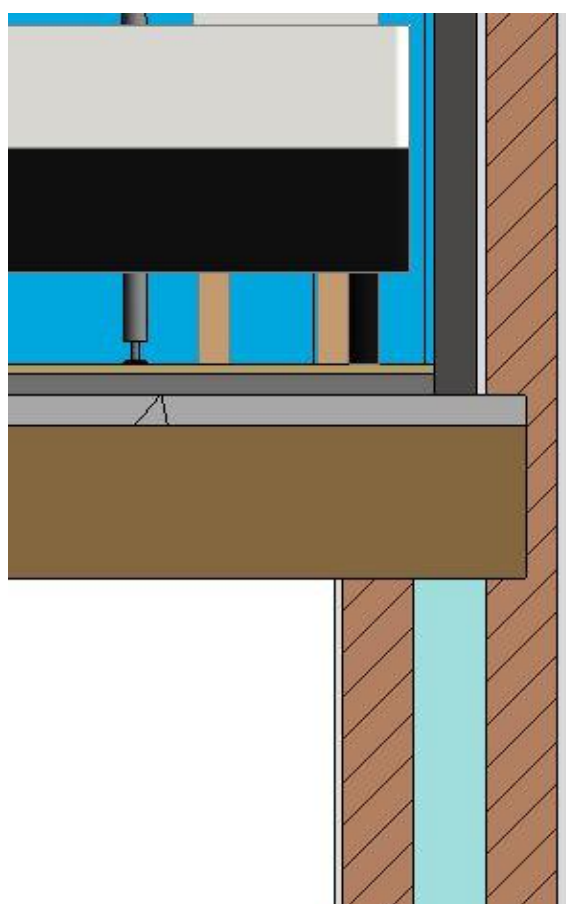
Detalle del encuentro de tabique con forjado en Revit. Fuente: Elaboración Propia
